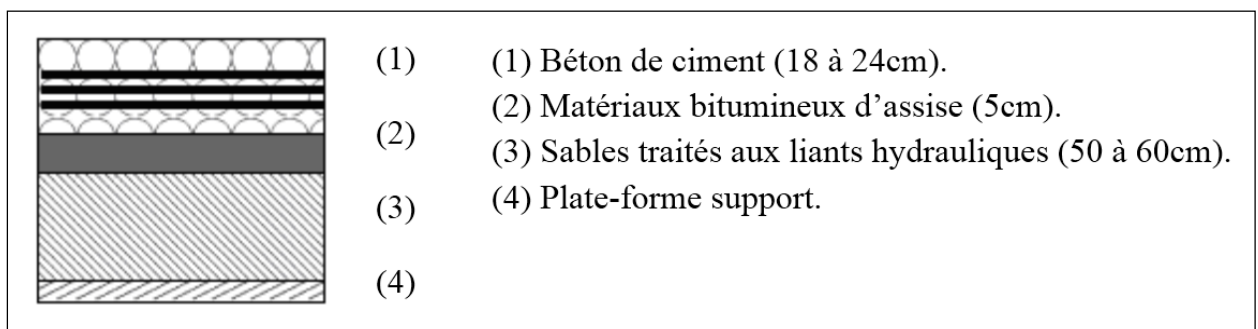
Structure d'une chaussée en béton armé continu (MEZIANI, 2008)
